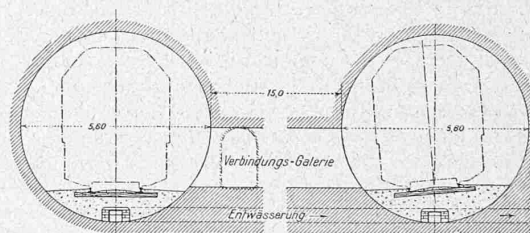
und 2. Lageplan und Längensprofil zum Kanal-Tunnel nach Projekt Sartiaux. — Abb. 3. Tunnel-Querschnitt 1:200.
